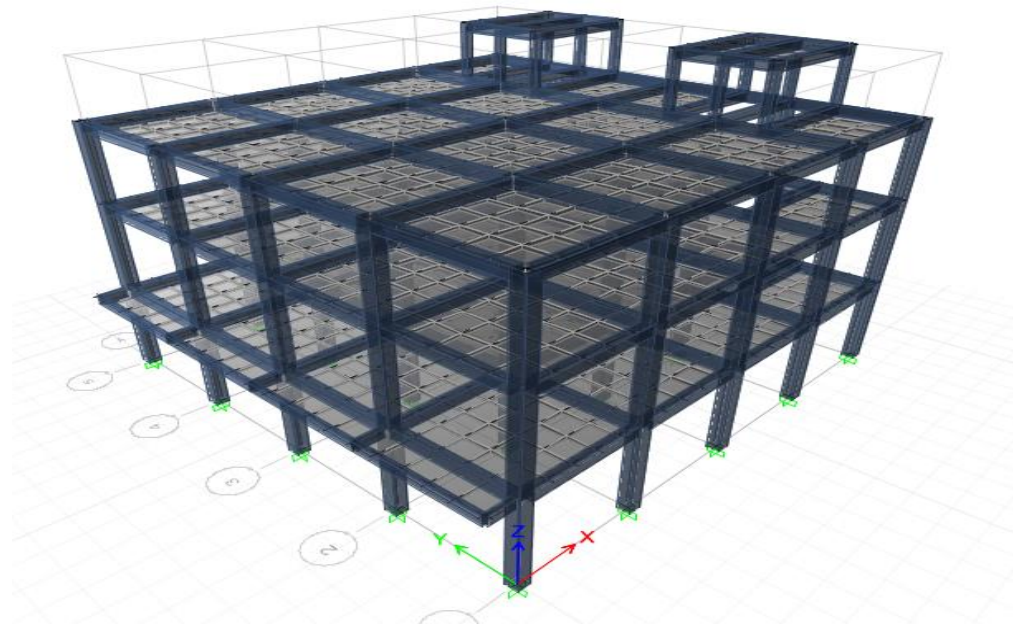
Denah struktur beton Model 1 Ruko A di lapangan.
